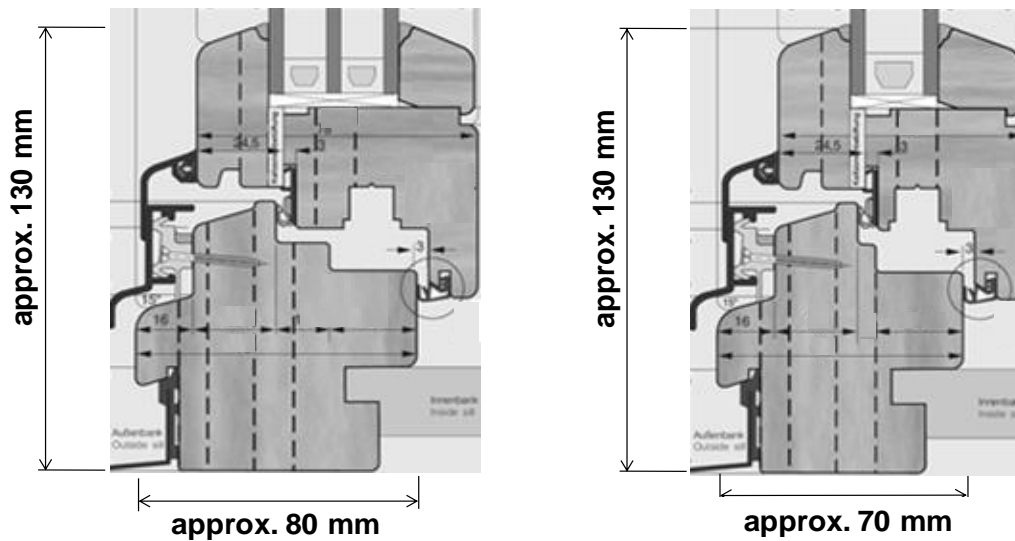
Holz-Aluminium-Fenstersystem (Berlin und Rom)
